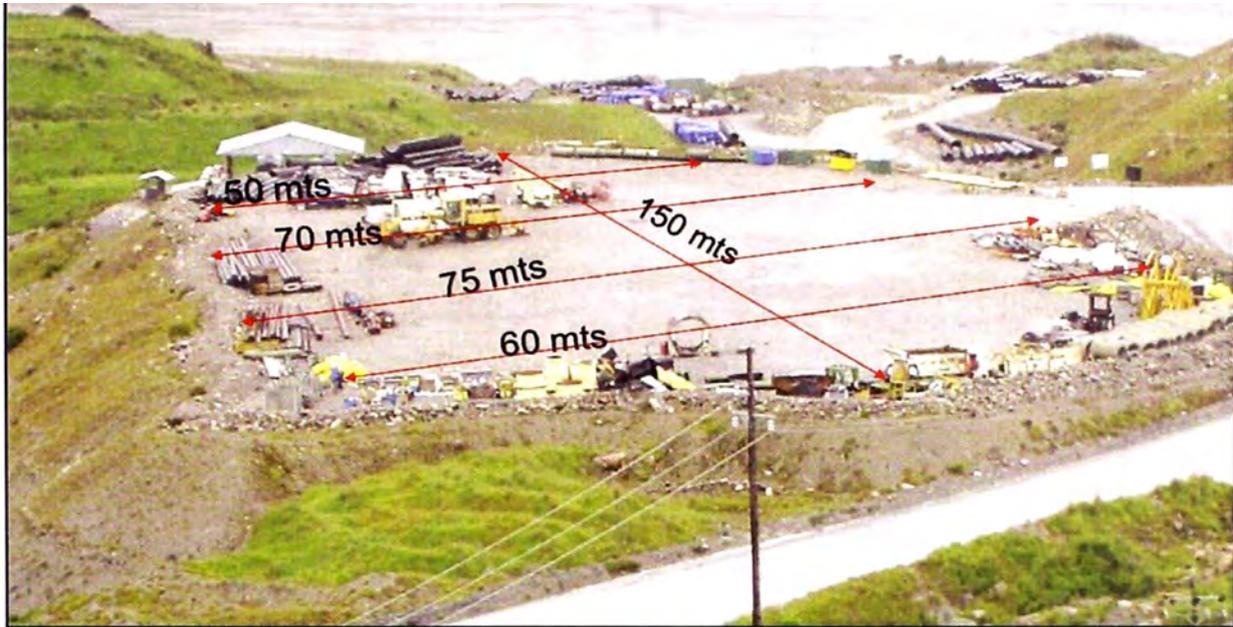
Vista panorámica del área destinada para la ubicación de la planta de concreto (Fuente: Archivo propio)
